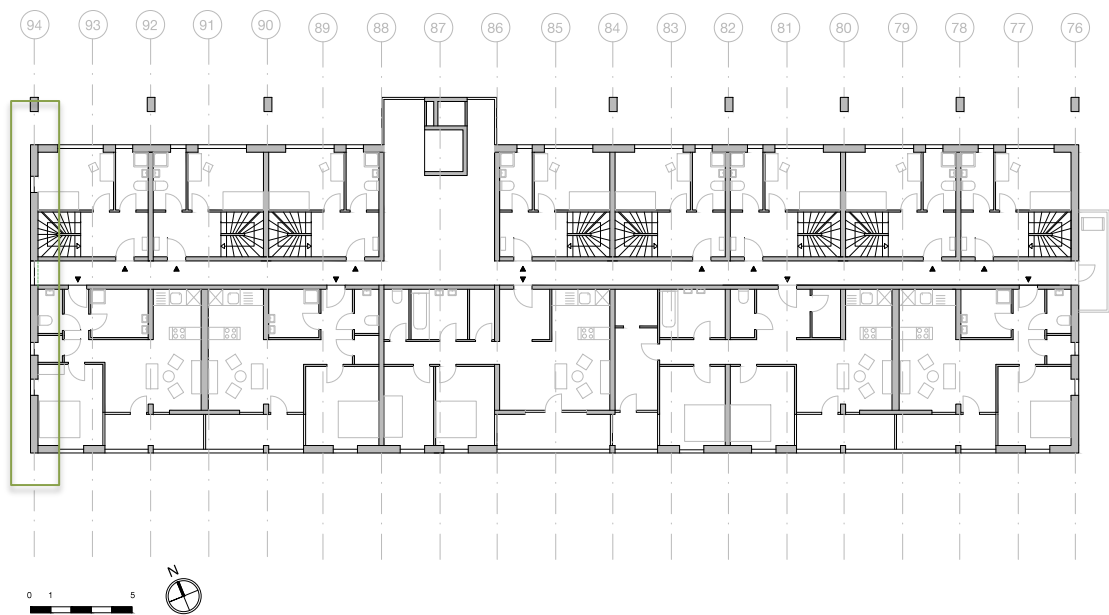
Grundriss eines Regelgeschosses mit ausgewählter Außenwand
